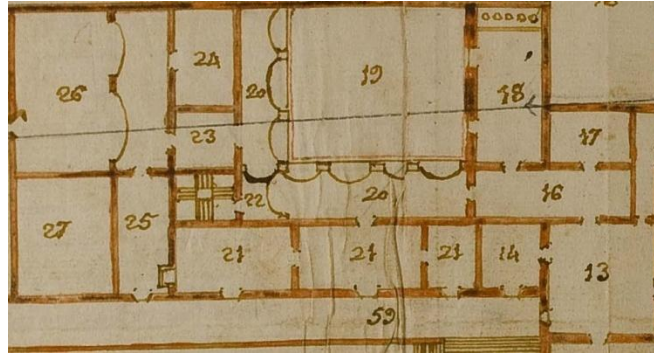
Velázquez Gaztelu. Detalle del plano levantado, 1762. Aposento de las Damas.
